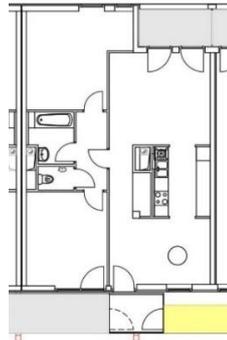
Wohnung mit zentralem Wohn/Ess/Kochbereich und Blickbeziehungen zu beiden Gebäudeseiten, Bauteil Arch. Podreka
